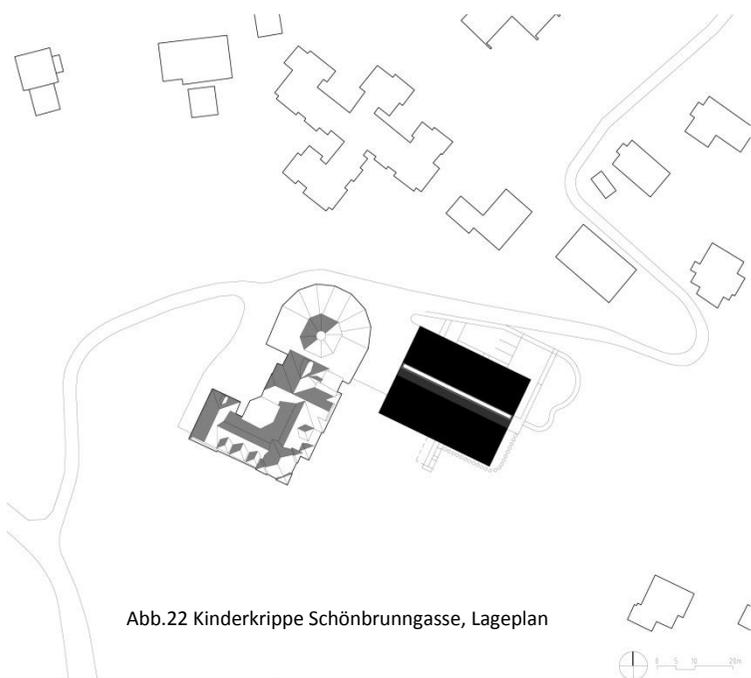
Kinderkrippe Schönbrunn, Lageplan
